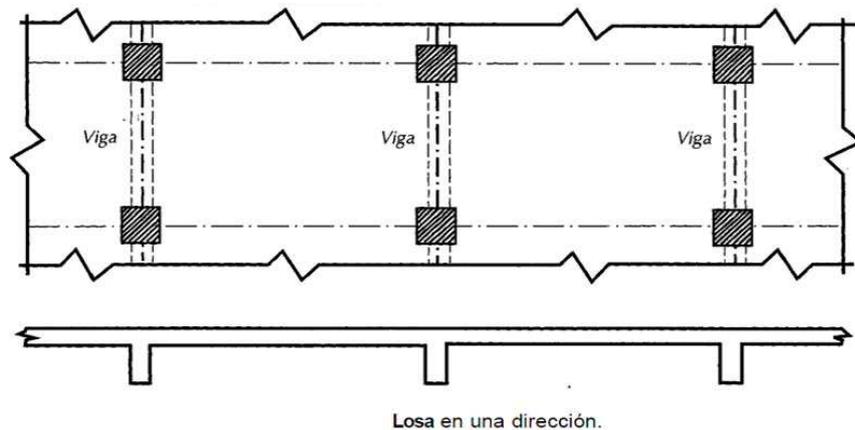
Losa en una dirección (A fine WordPress.com site, 2013)
